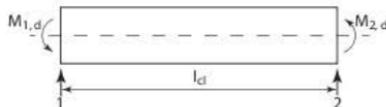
Moments aux extrémités de la poutre
